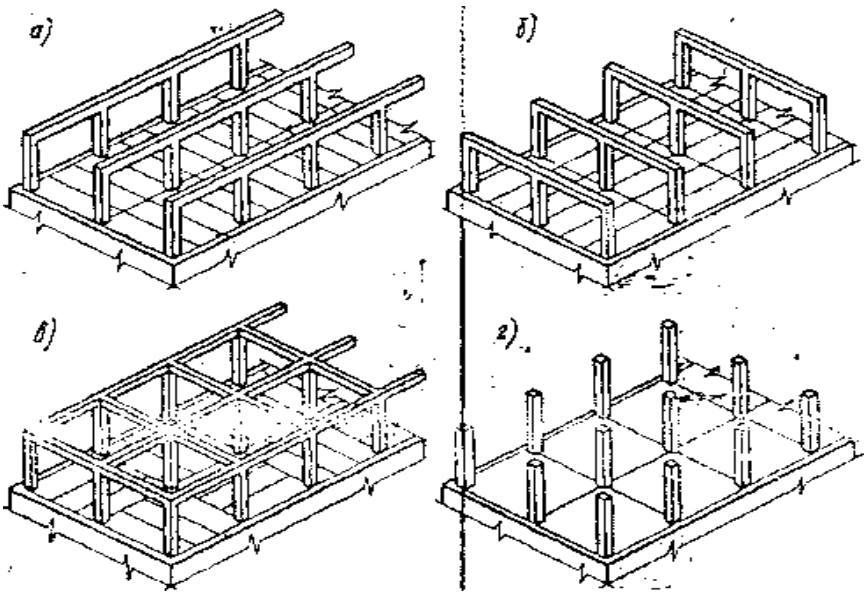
Конструктивні системи каркасних будівель: а - з поздовжнім розташування ригелів; б - з поперечним розташування ригелів; в - з перехресним розташування ригелів; г - безригельна
